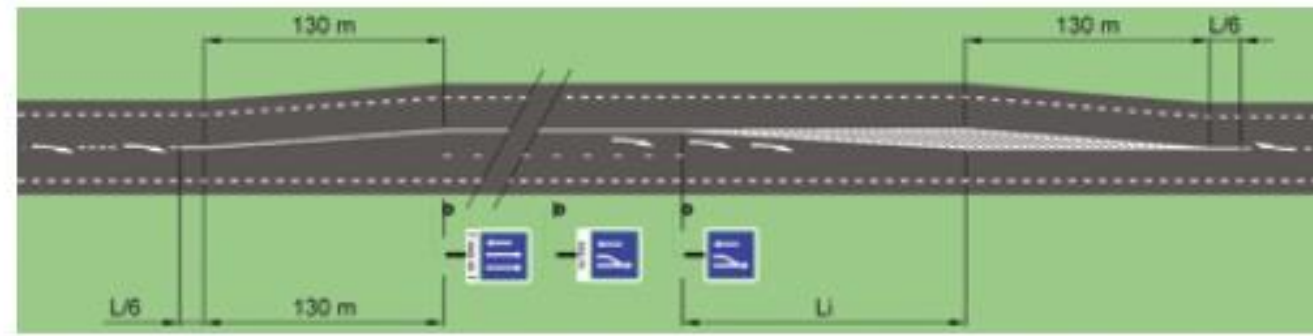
Schéma de construction d'un créneau de dépassement – ARP 2022
